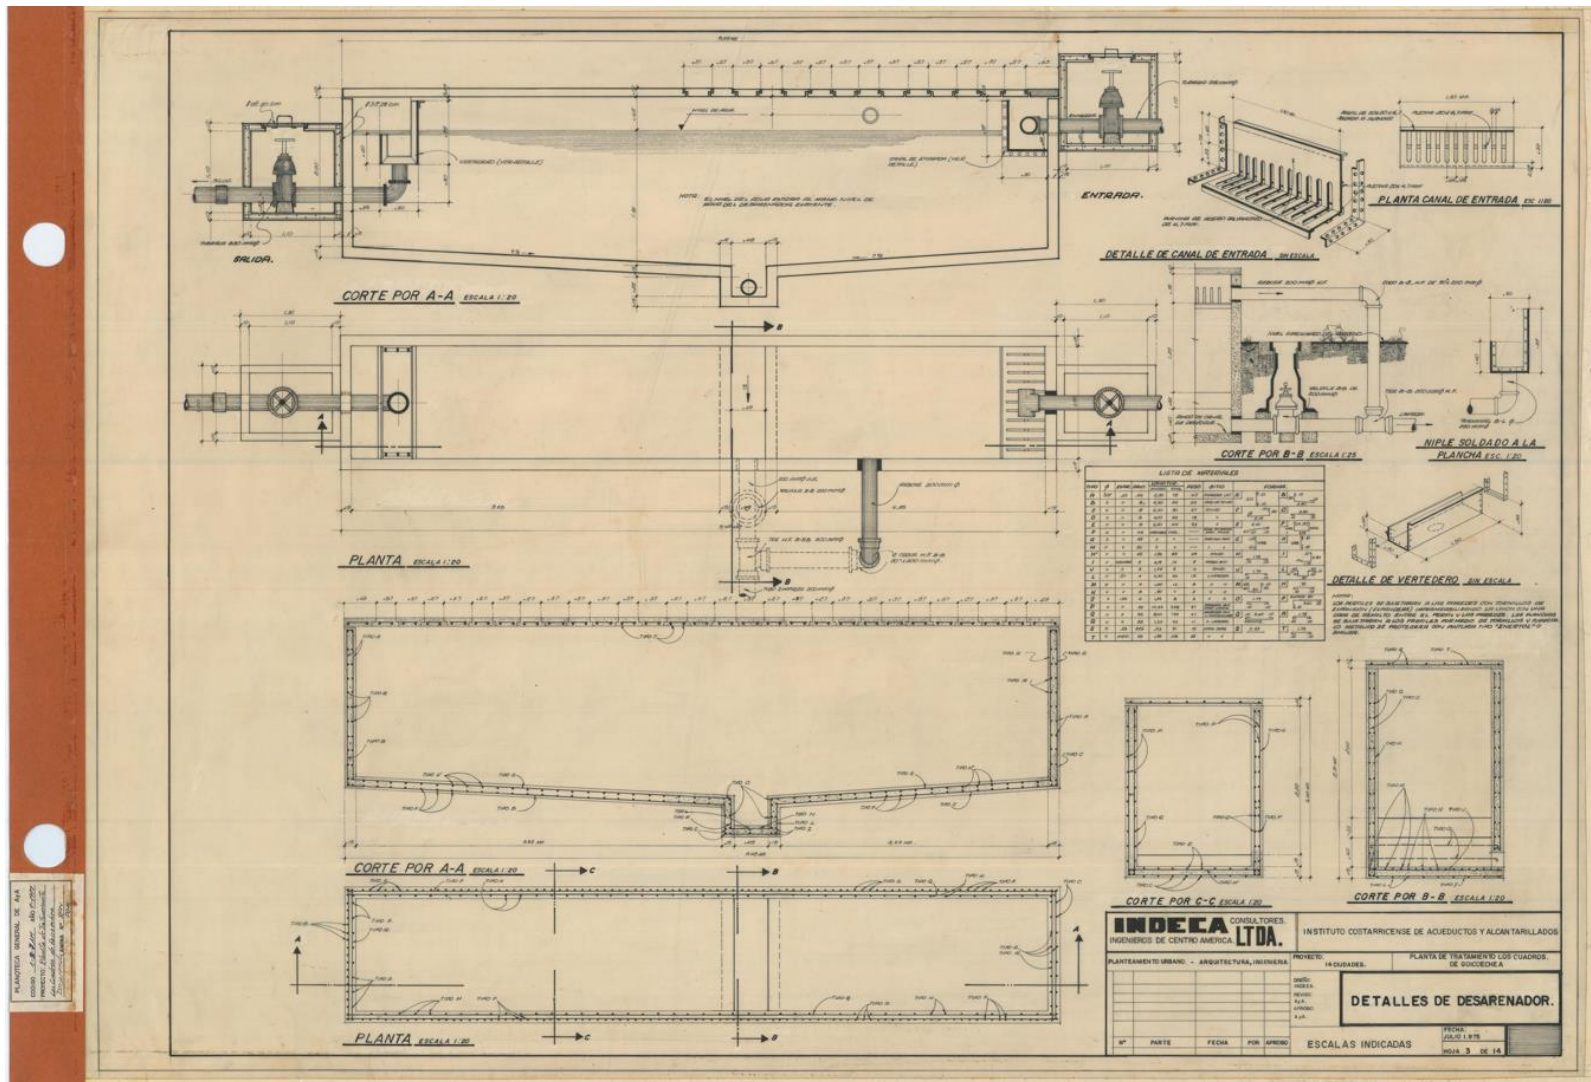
Desarenador corte Longitudinal y detalle estructural / Fuente AyA
